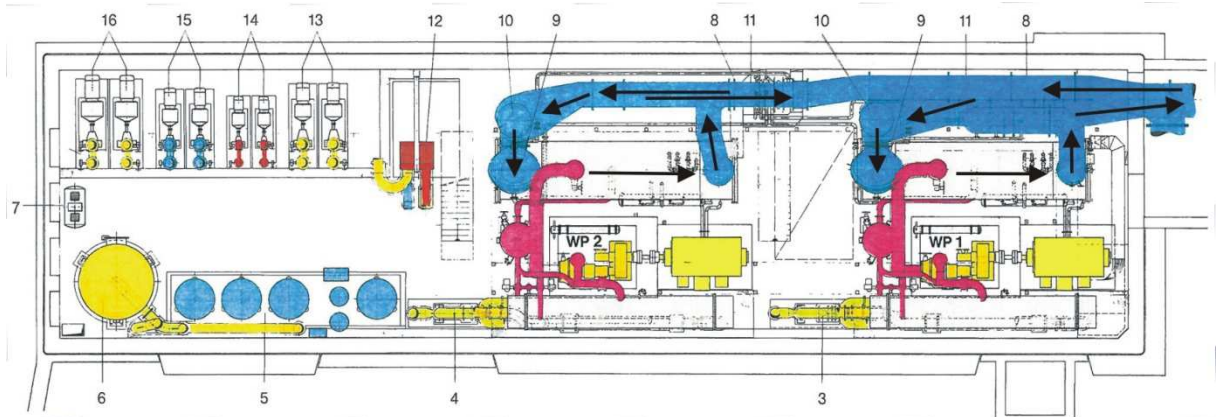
Grundrissplan der WP-Anlage Walche mit zwei gekoppelten WP (verändert nach: AMT FÜR BUNDESBAUTEN, 1988)
